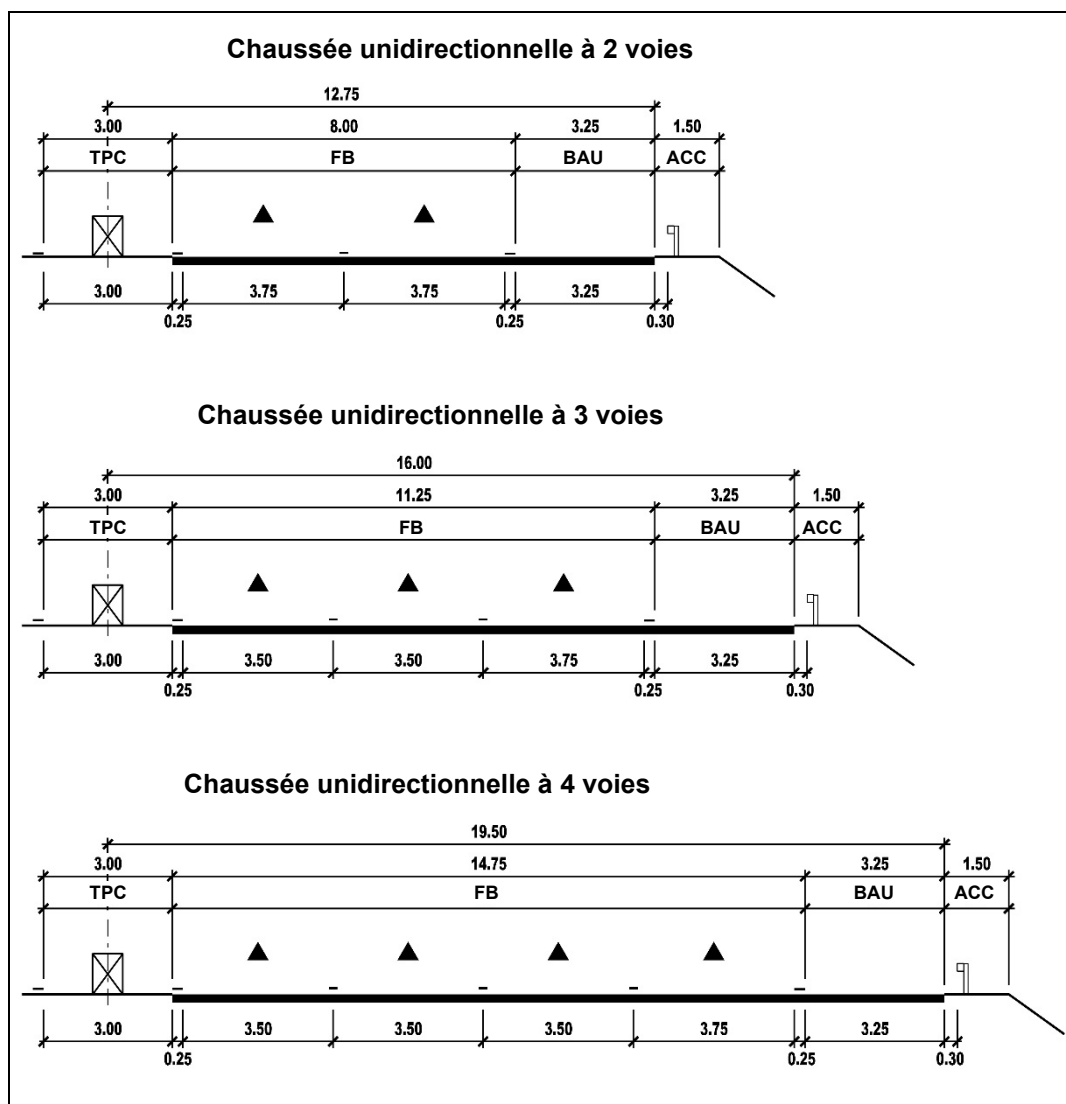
Profils standard (chaussées unidirectionnelles à 2, 3 et 4 voies)
